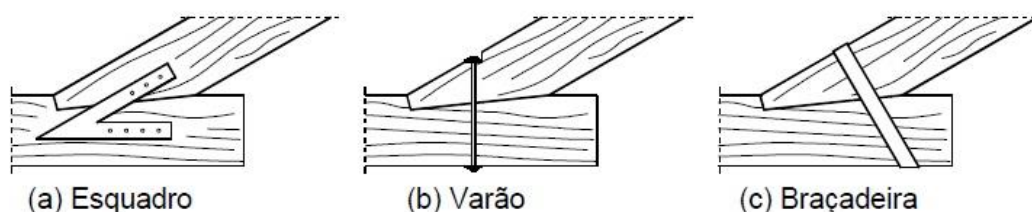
Ligações entalhadas com elementos metálicos de reforço (Branco, Cruz, & Piazza, 2006)
